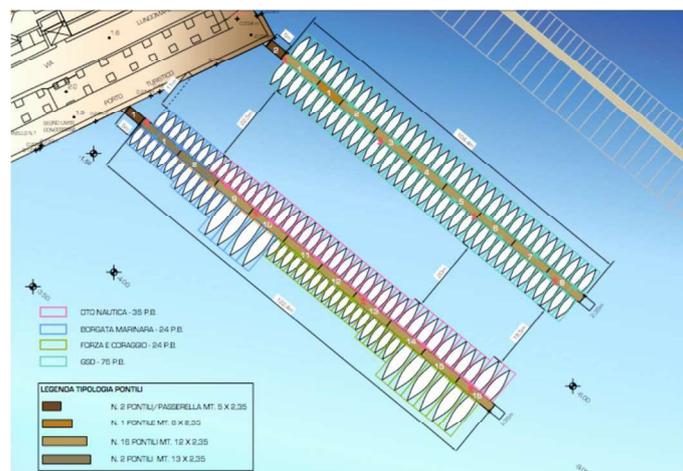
Soluzione progettuale finale (dettaglio) (da Progetto\_Relazione Tecnica, Studio Architetto Roberto Evaristi).
